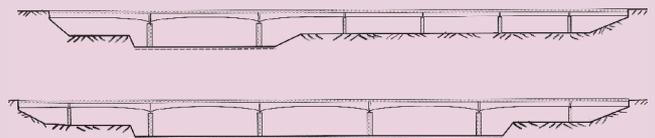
Ouvrages avec tabliers comportant des zones de hauteur constante et des zones de hauteur variable
